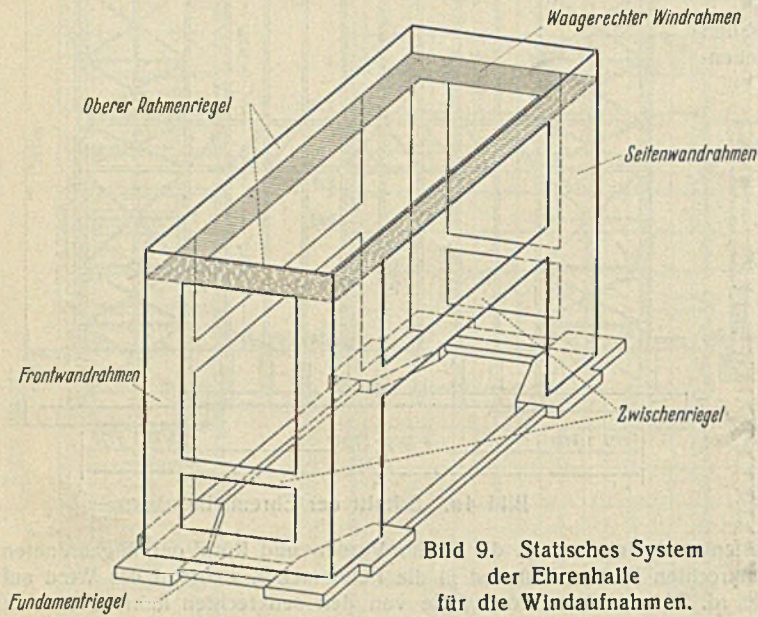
Statisches System der Ehrenhalle für die Windaufnahmen.
